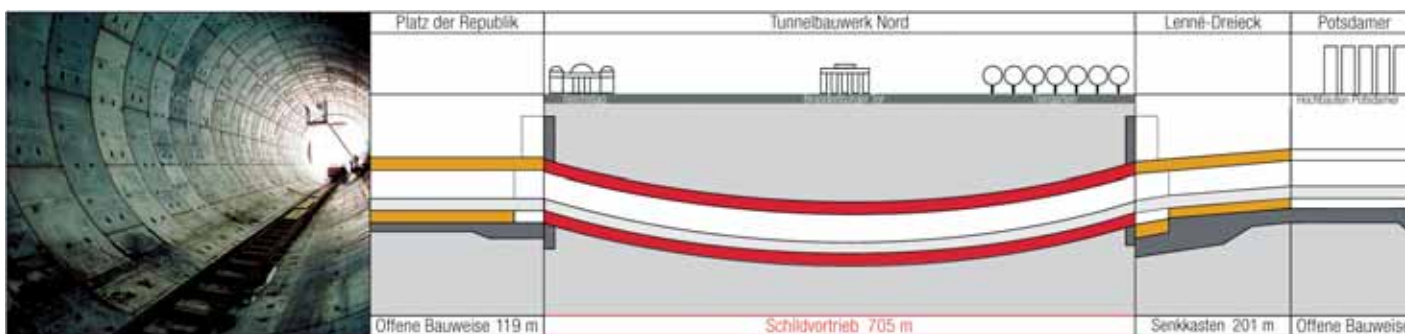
Die Tunnelstrecke und ihre Bauweisen
